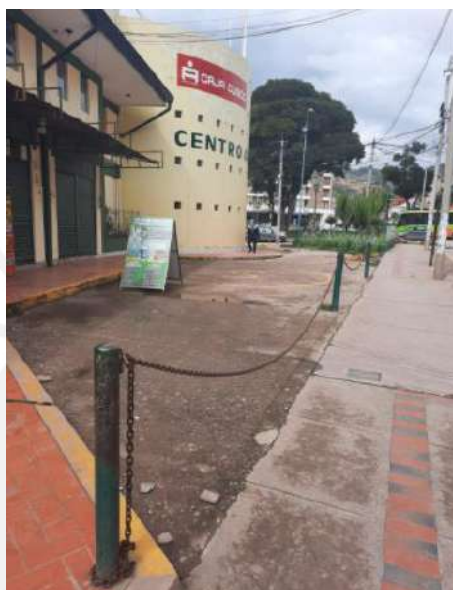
Estacionamiento público ubicado en avenida Tullumayo (esquina de avenida Tullumayo con avenida Pachacutec) con ausencia de señalización vertical y con acceso restringido. Fuente: propia.
